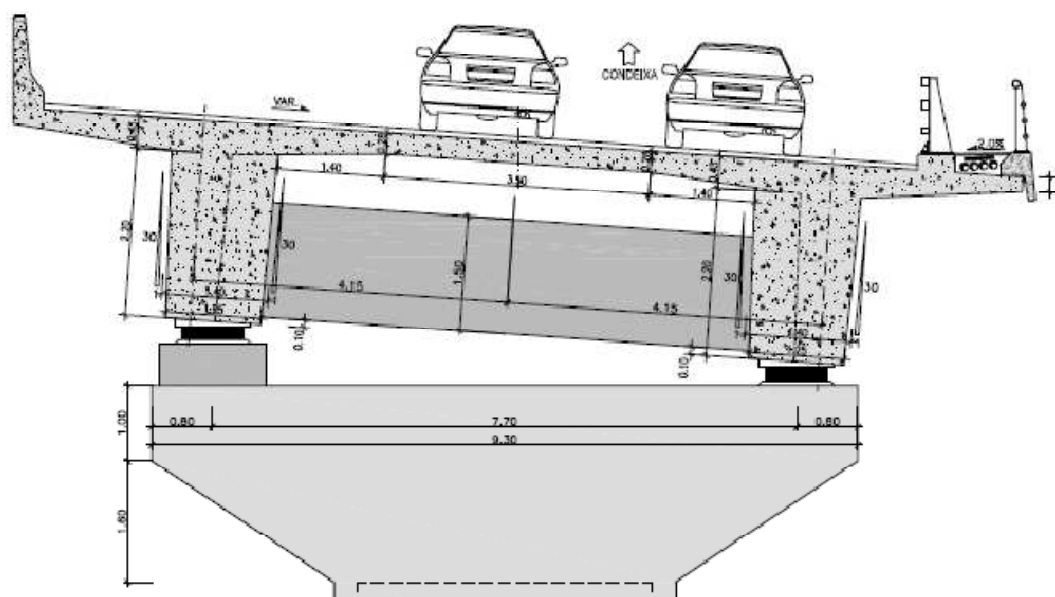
Ilustração da secção transversal do tabuleiro no pilar
